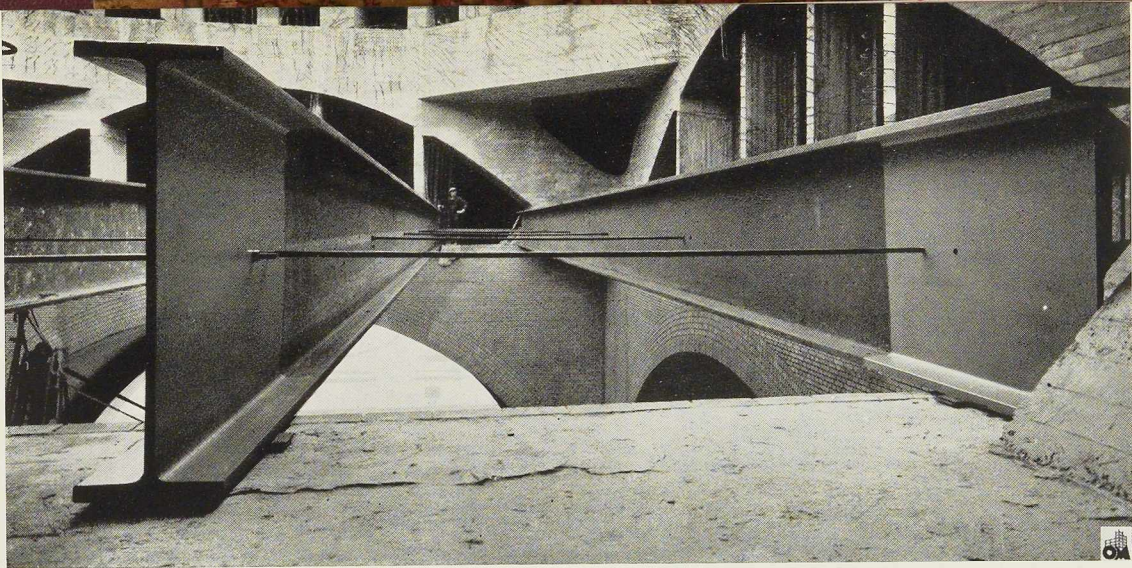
Vue prise de face montrant la section des poutrelles DIN 100.
